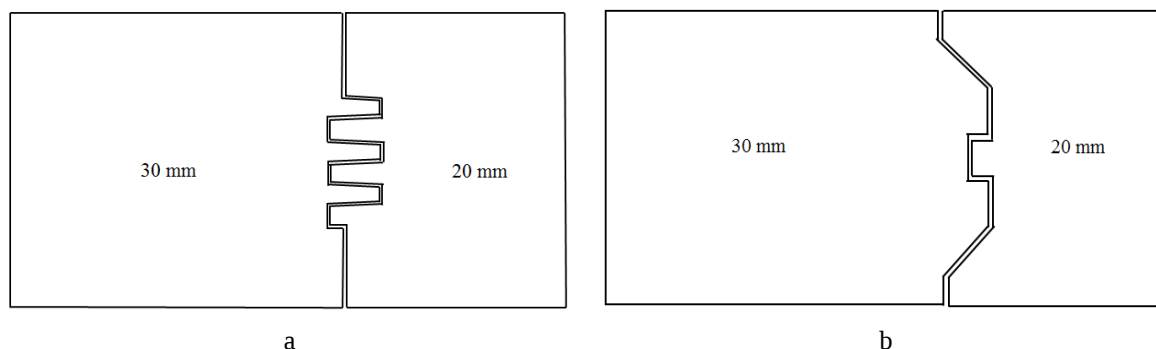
21- Seccionamento dos painéis: a) Em 3 partes; b) Peças menores.
